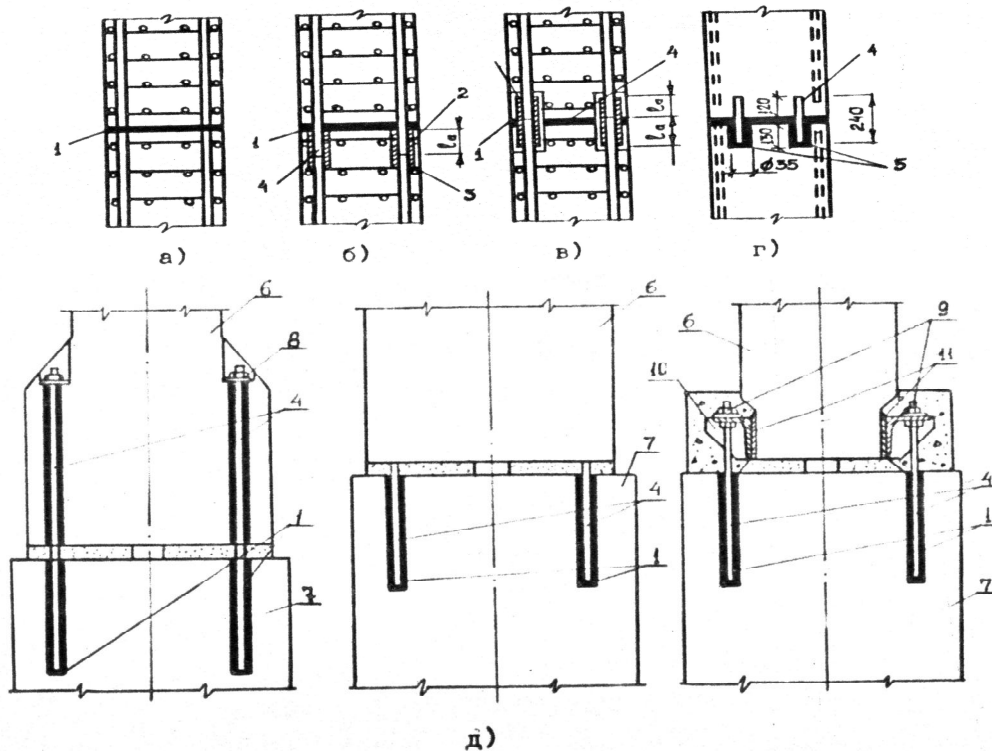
Клейові стики збірних залізобетонних колон (а, б, в), паль (г) і збірних залізобетонних колон із безстаканними фундаментами (д):
